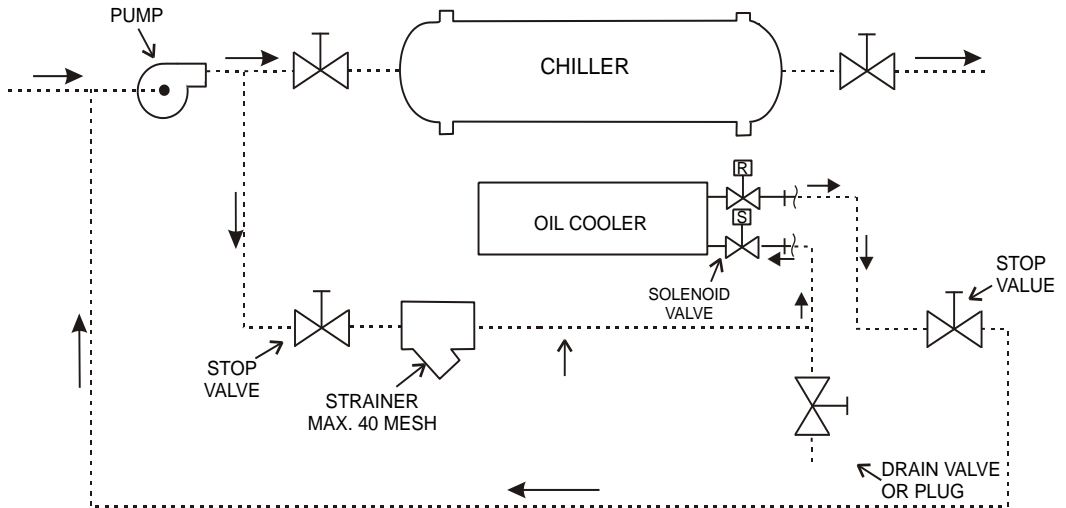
Схема трубопровода маслоохладителя с использованием городского водопровода
